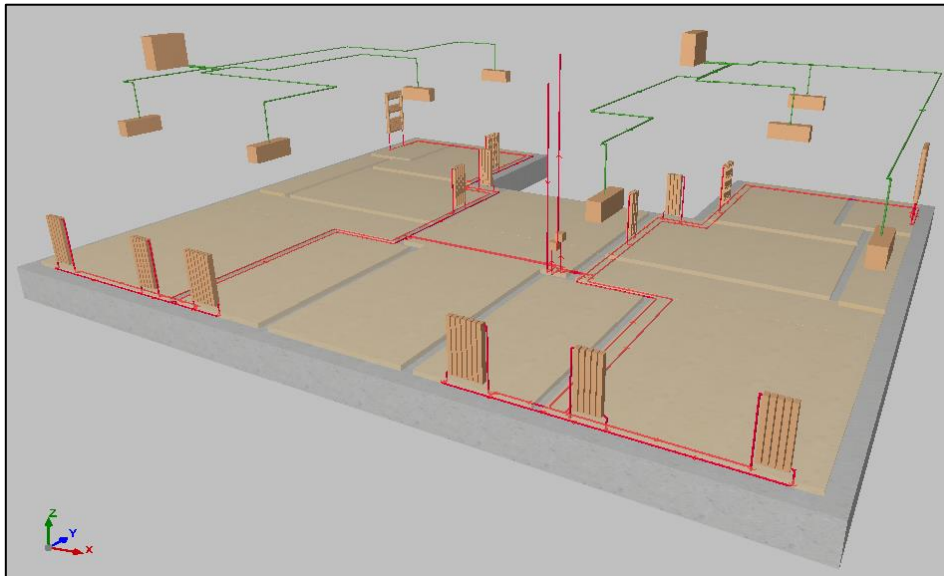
Equipos de climatización, planta baja. Modelo 3D CypeCAD MEP.
